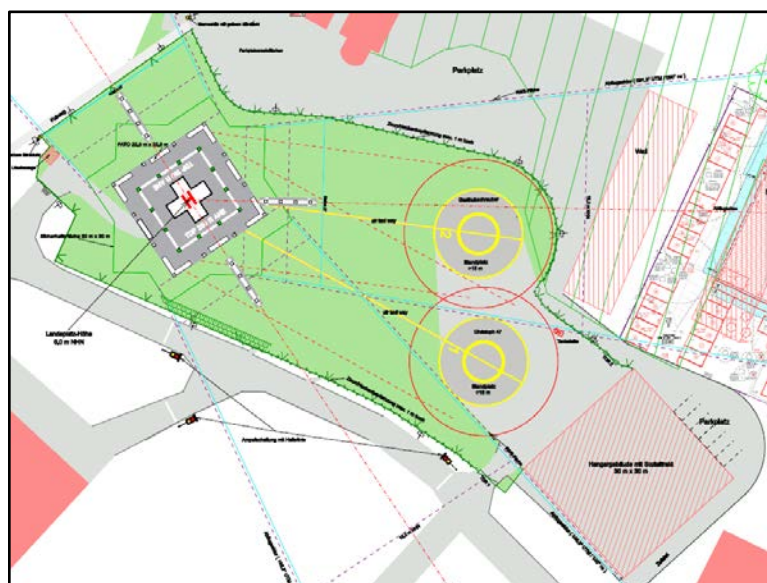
Vorgeschlagenes Layout der Luftrettungsstation Greifswald
